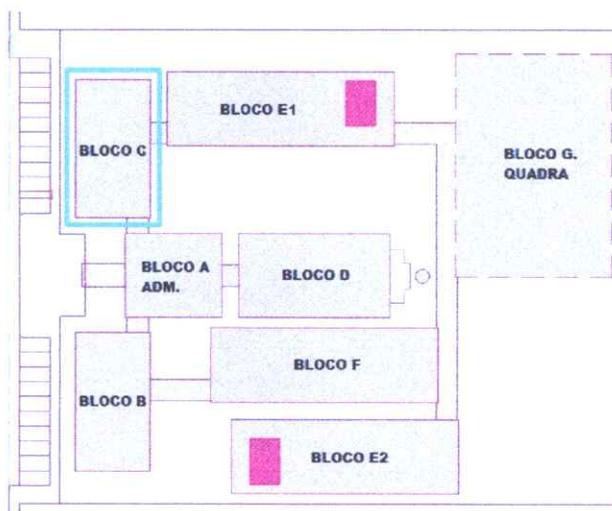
Layout dos Blocos, conforme Projeto de Arquitetura. Fonte: Projeto Padrão FNDE.
